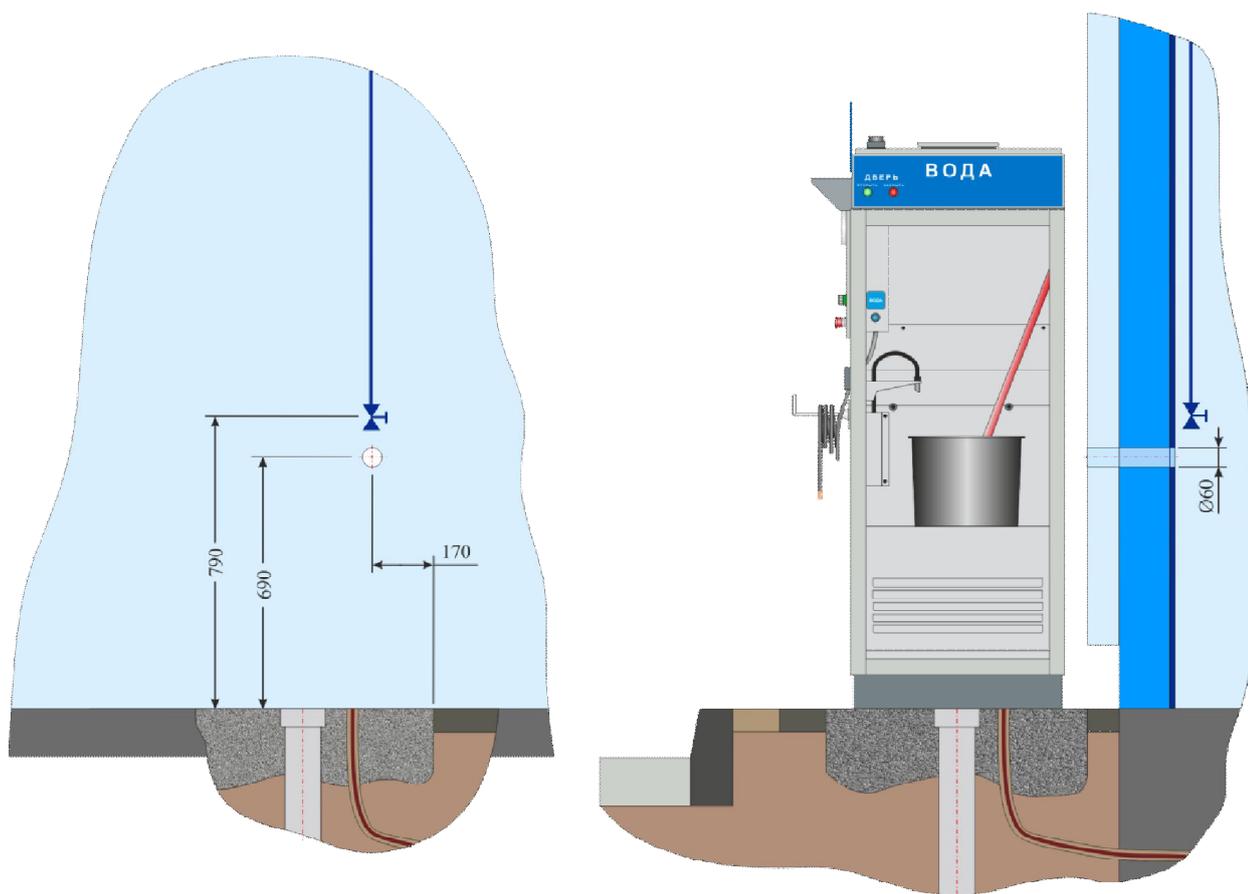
Схема расположения запорной арматуры на внутренней отделке стены здания АЗС (слева – вид изнутри помещения АЗС)
